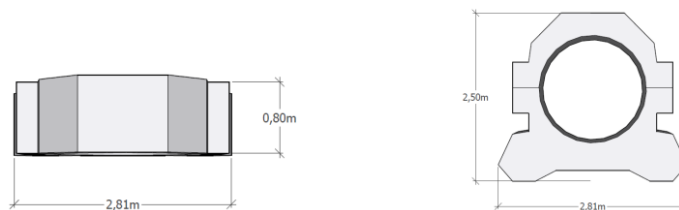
Emissário Submarino de Tunes. Planta e alçado frontal dos blocos de lastro
